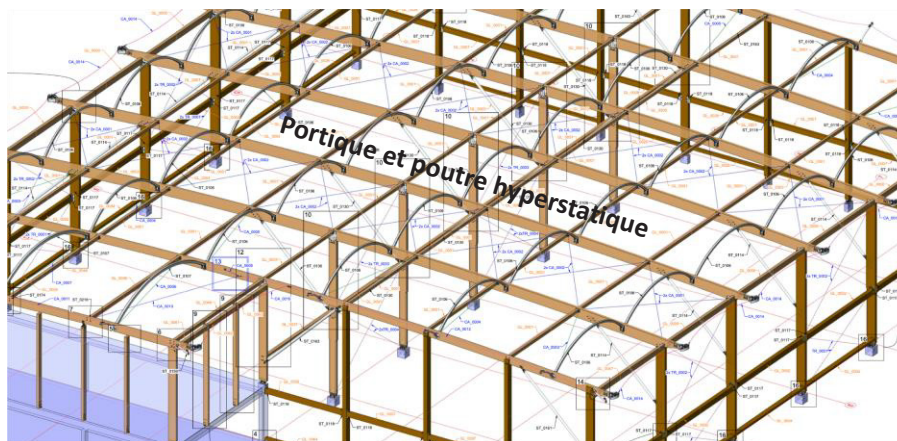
structure hyperstatique poteau - poutre en bois GL24h
